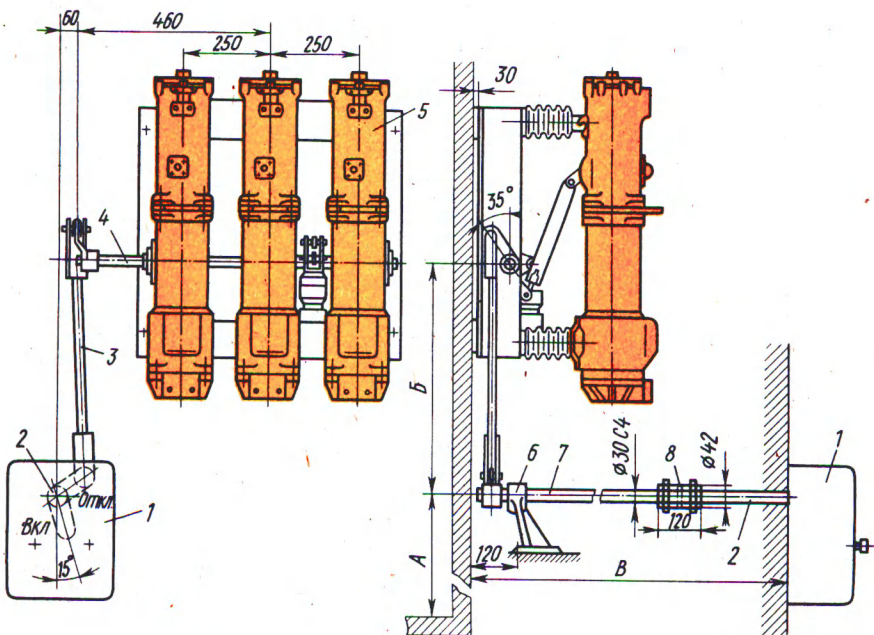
Установочный чертеж масляного выключателя ВМП с приводом ПЭ-11 в ячейке КСО
